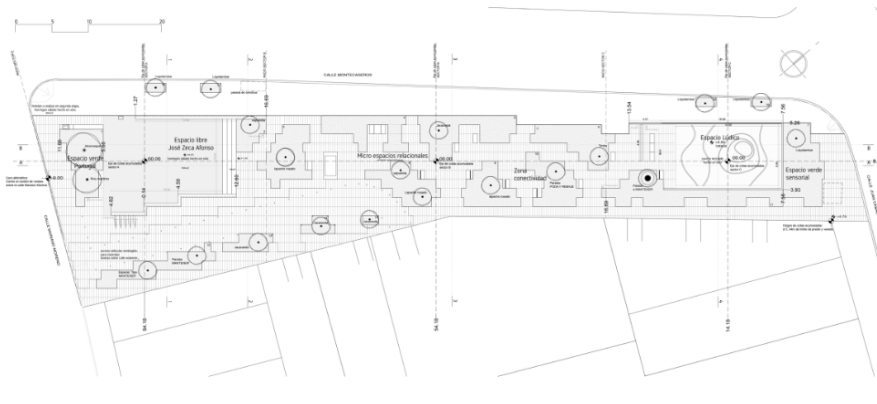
Plaza Portugal. Planta general (fuente: elaboración propia, 2015).
